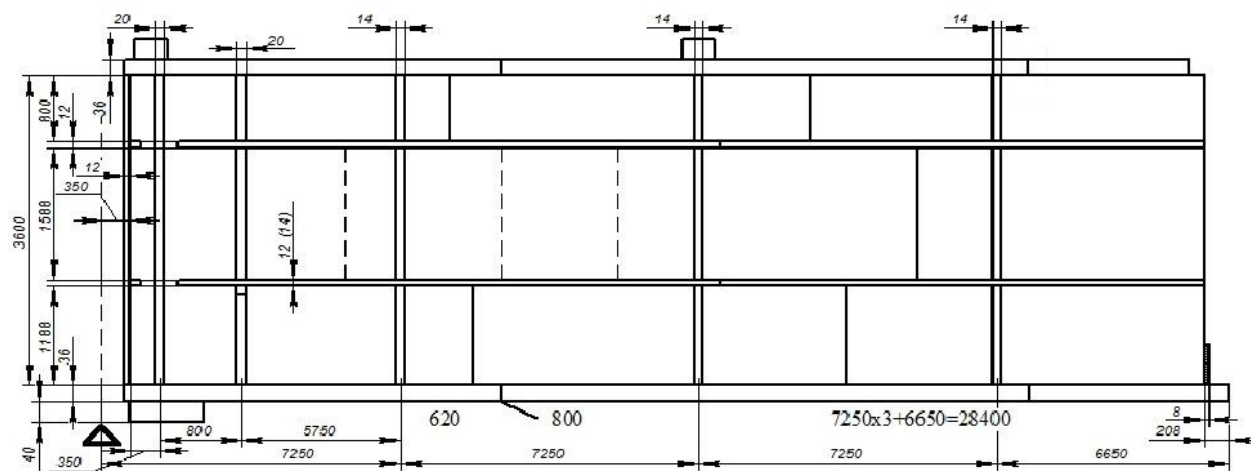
Поперечний переріз головної поздовжньої балки двотаврового перетину
